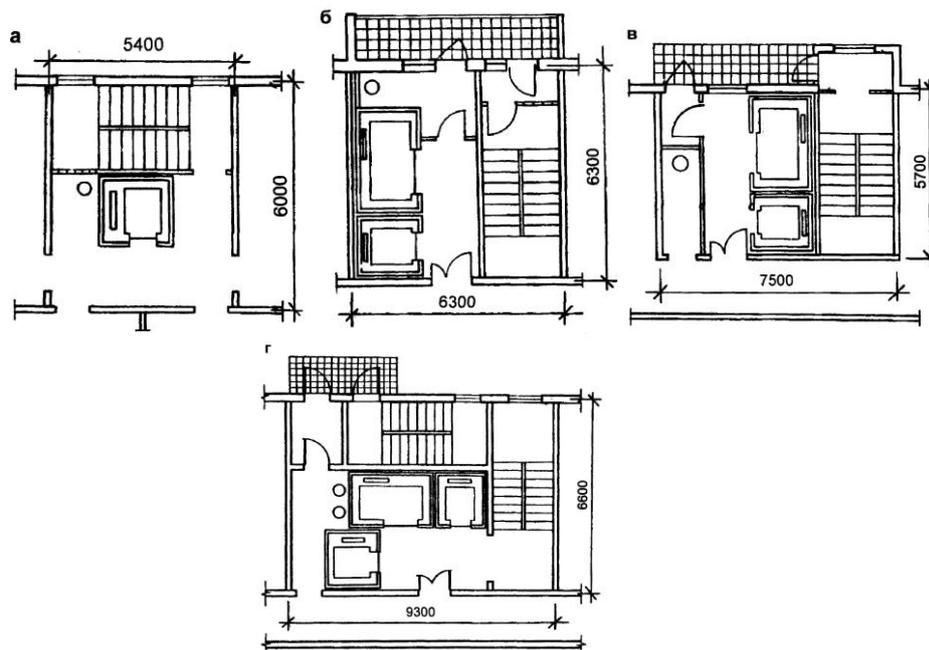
Примеры планировочных решений лестнично-лифтовых узлов зданий: а – 9-этажного; б, в – 16-этажных с незадымляемой лестницей; г – 25-этажного с двумя лестницами
